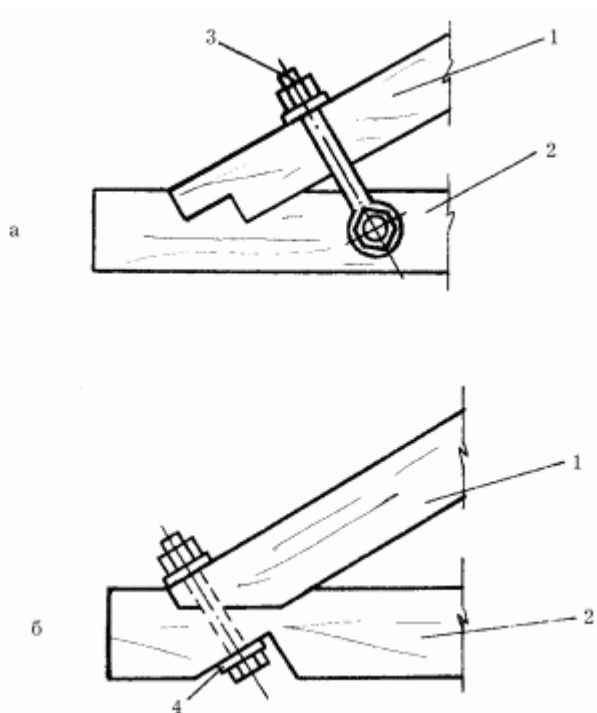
Соединение стропил: а – болтом; б – хомутом; 1 – стропильная нога; 2 – затяжка; 3 – болт; 4 – хомут.
